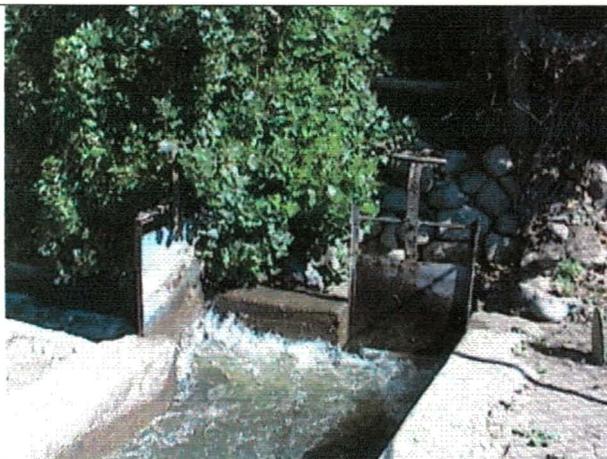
Compuerta de Entrega Canal Las Pircas
